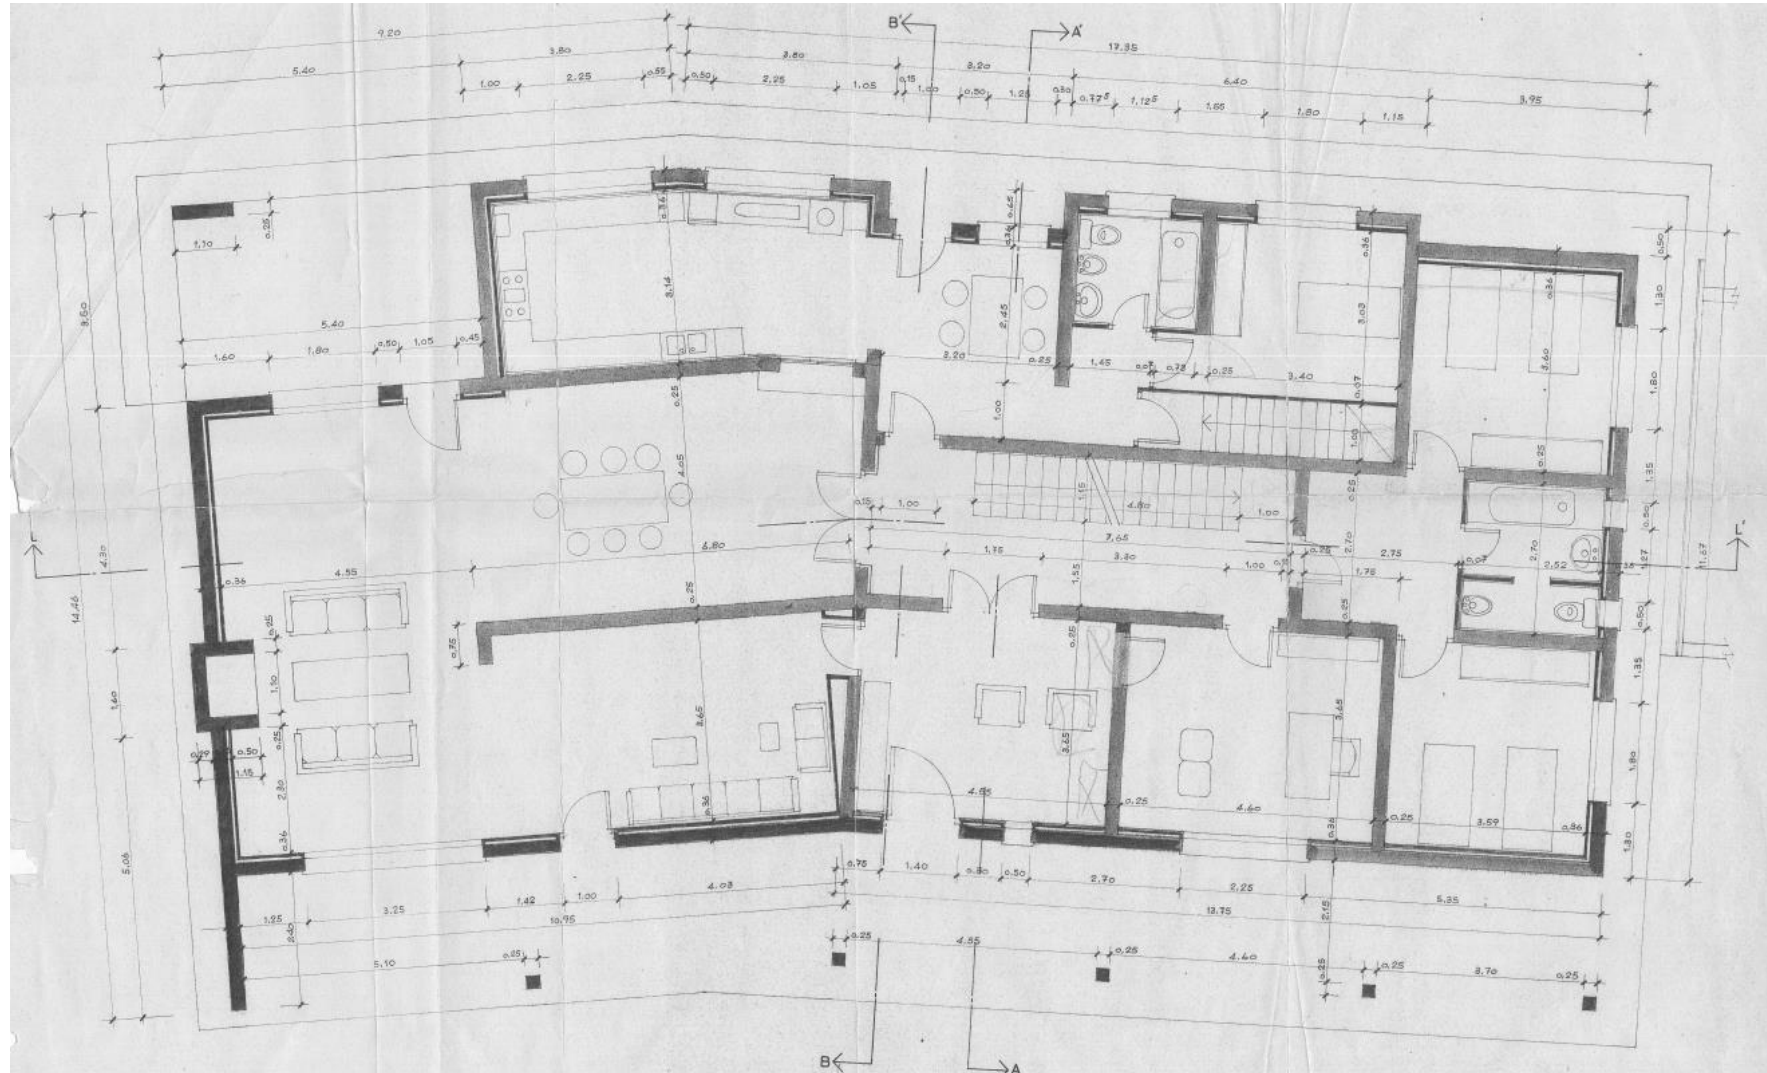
Imagen del plano original de la Primera Planta (Fuente: Planos originales realizados por D. Antonio Miranda Sánchez)
